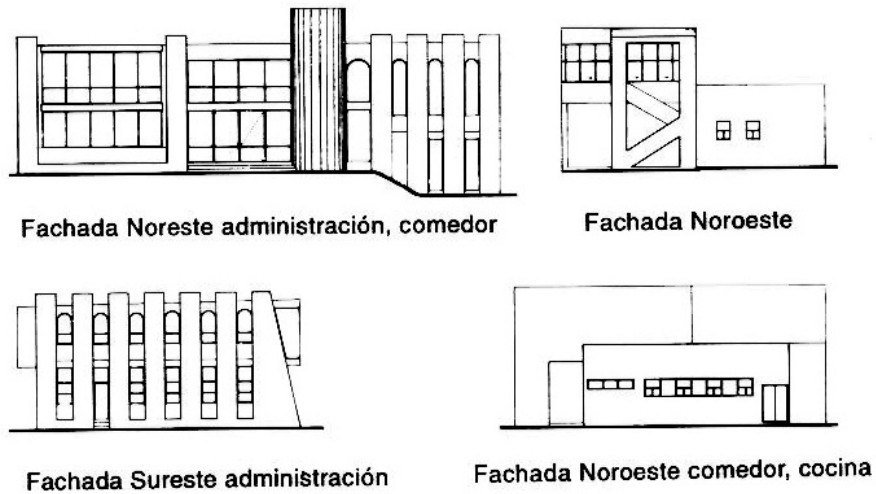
Fachadas de Casa Hogar para Niños Irma Arellano.
